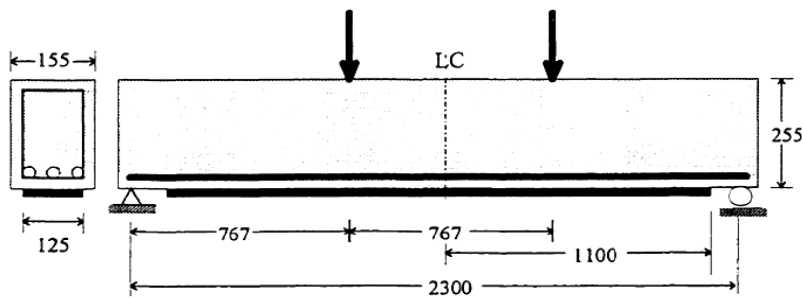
Poutre en béton armé renforcée à l'aide d'une plaque d'acier (16).
